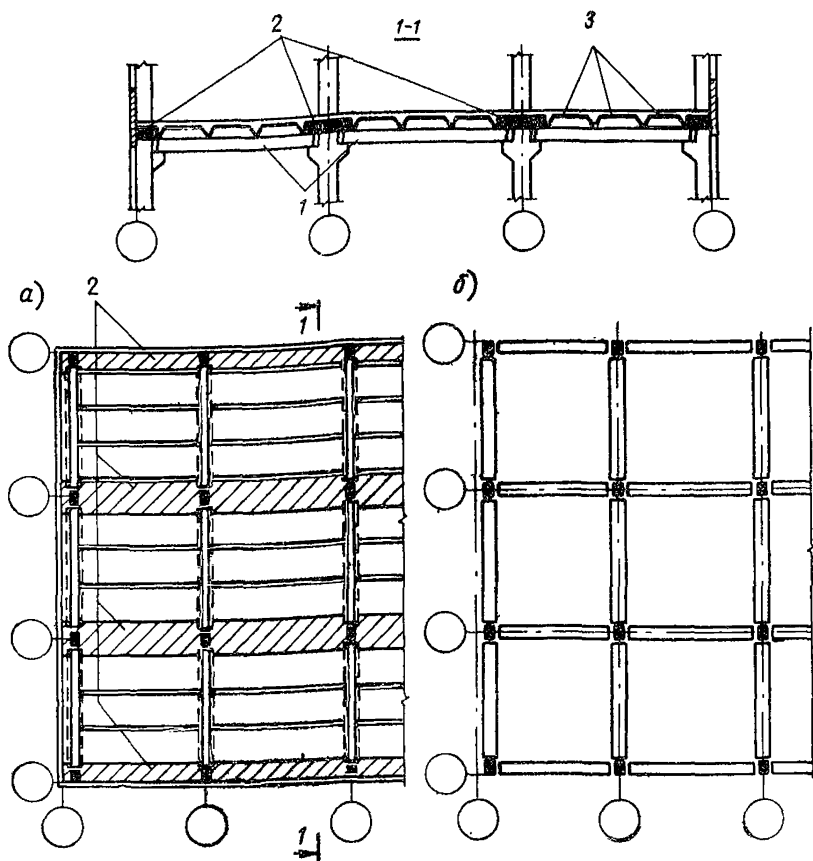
Перекрытия (покрытия) многоэтажного здания
